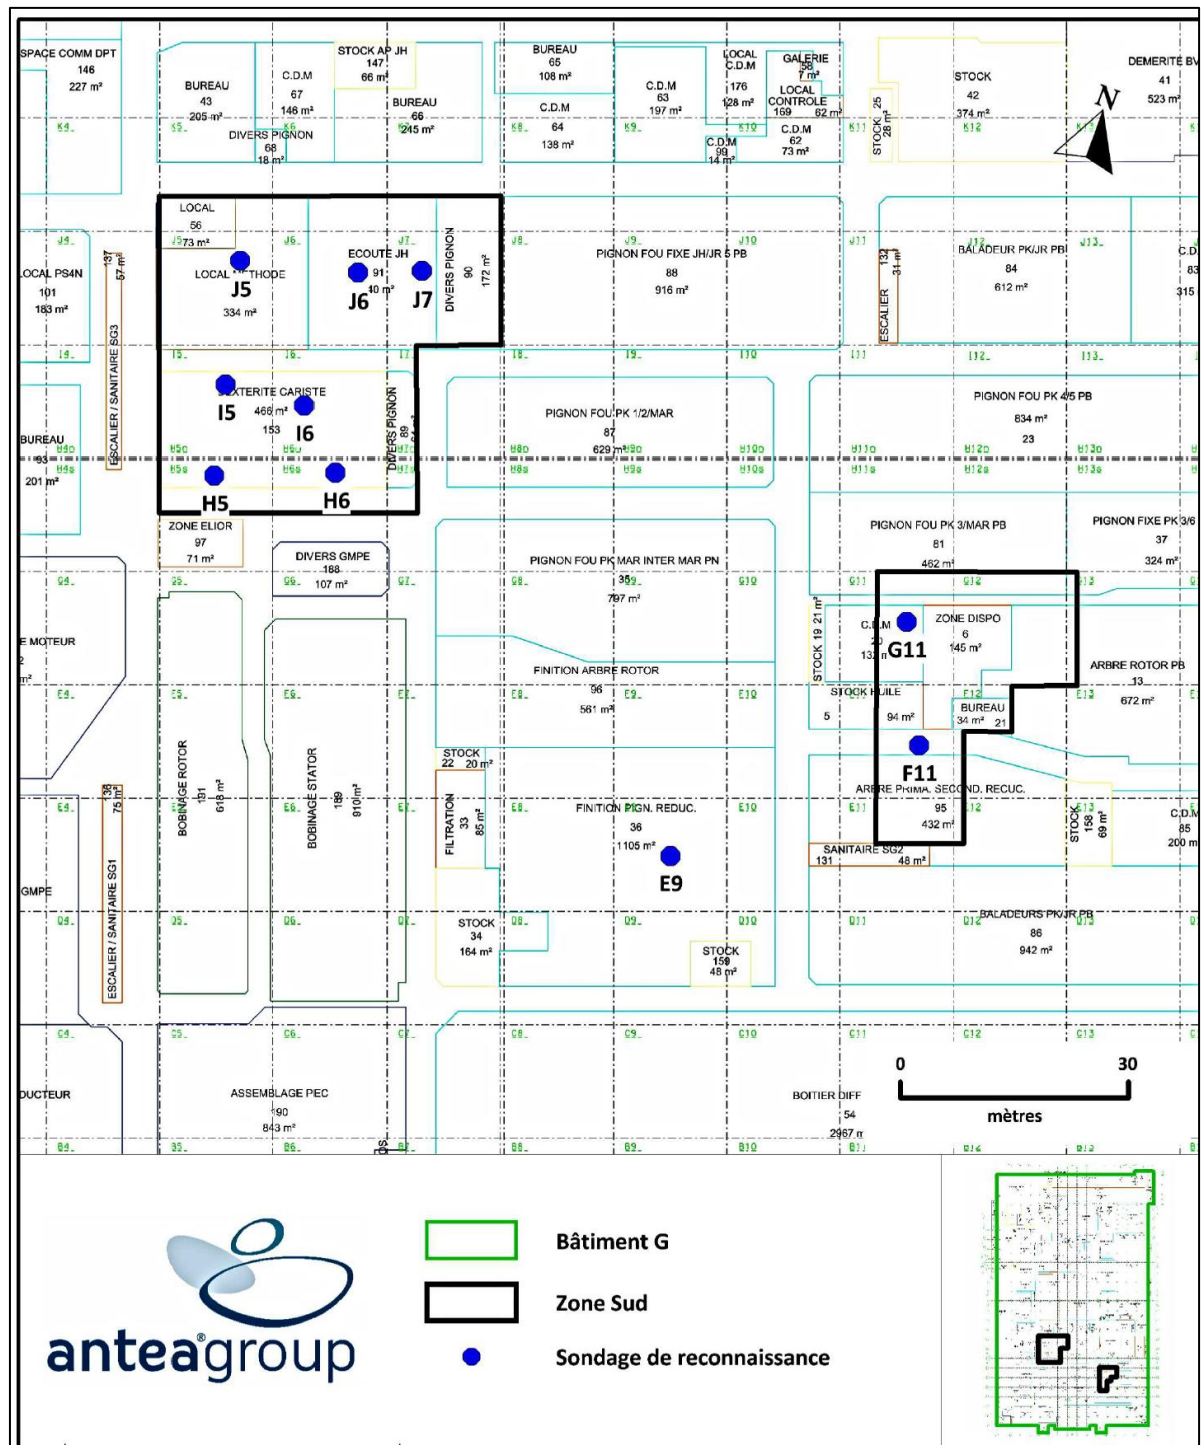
Plan de localisation des sondages dans la zone sud (source : rapport n°93652/C, Antea Group Avril 2018)
